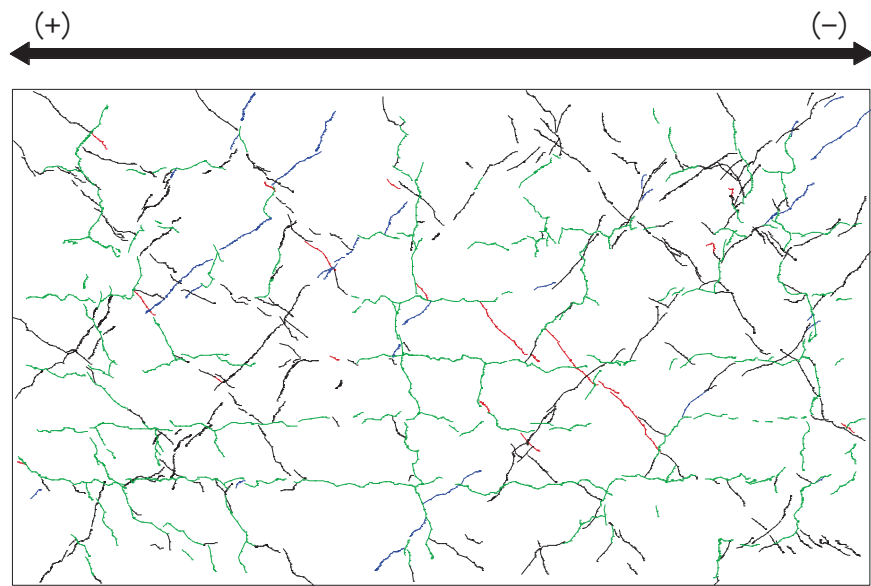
(8) 乾燥試験体 [2] 1/1000rad. におけるひび割れ図
